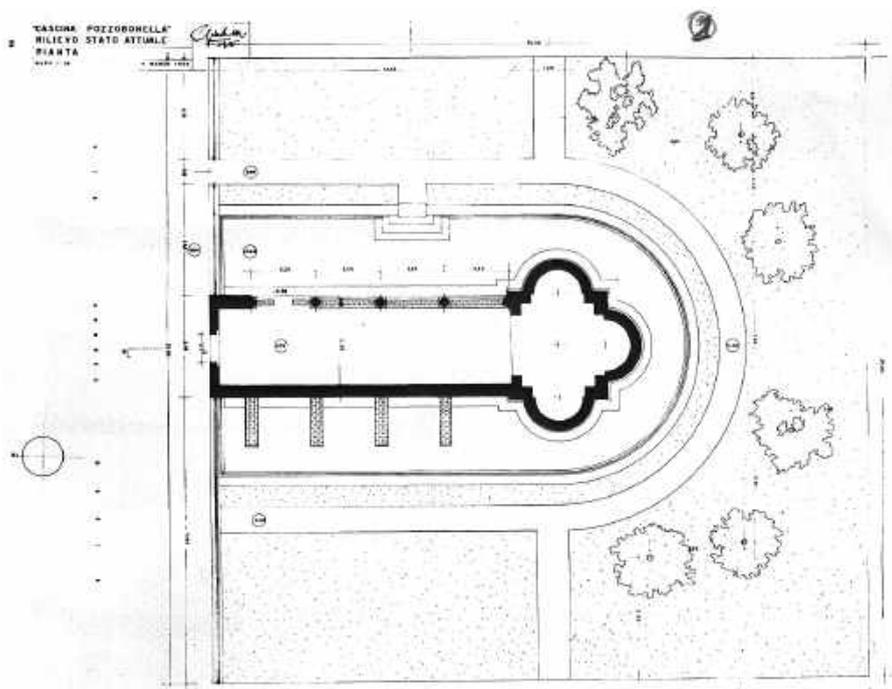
Pianta piano terra, prima dei lavori di restauro
